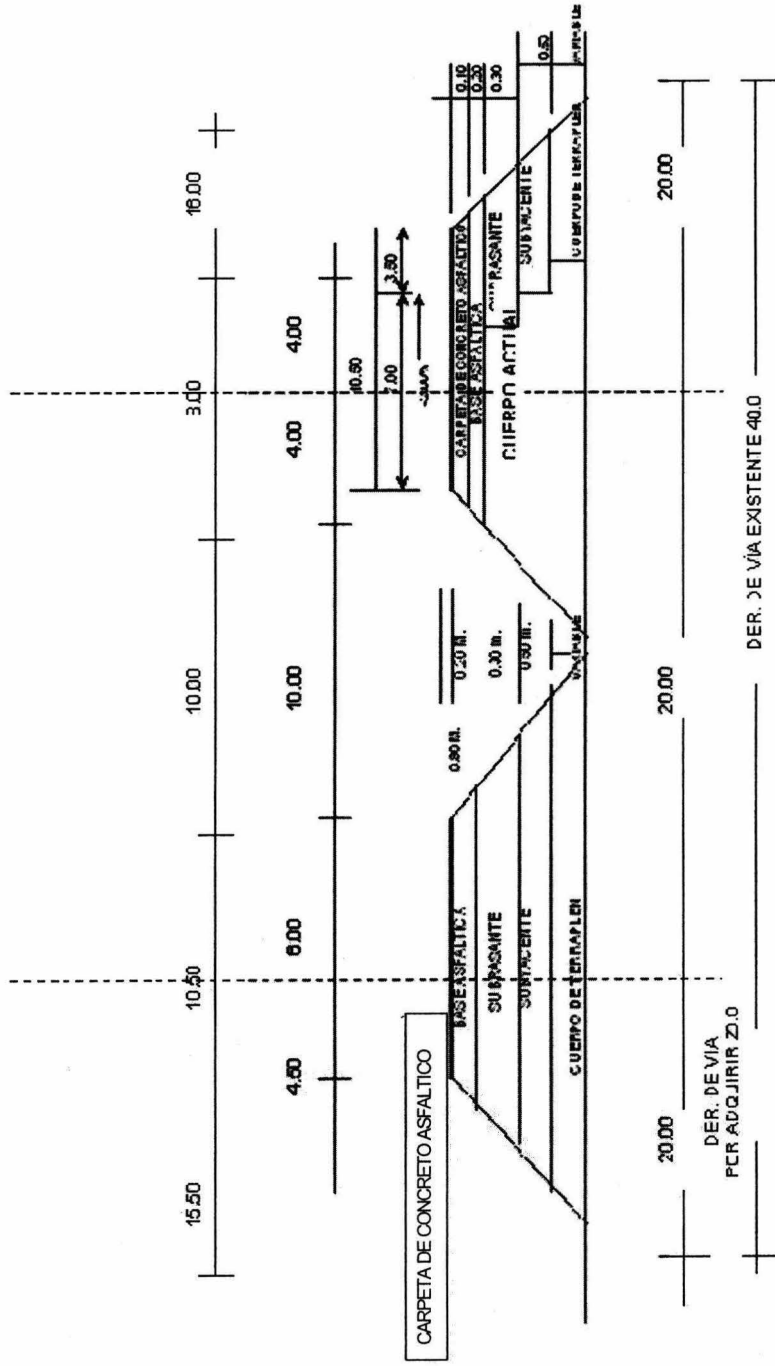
Sección tipo que especifica las dimensiones del proyecto en sección transversal de los 5 kilómetros proyectados.
